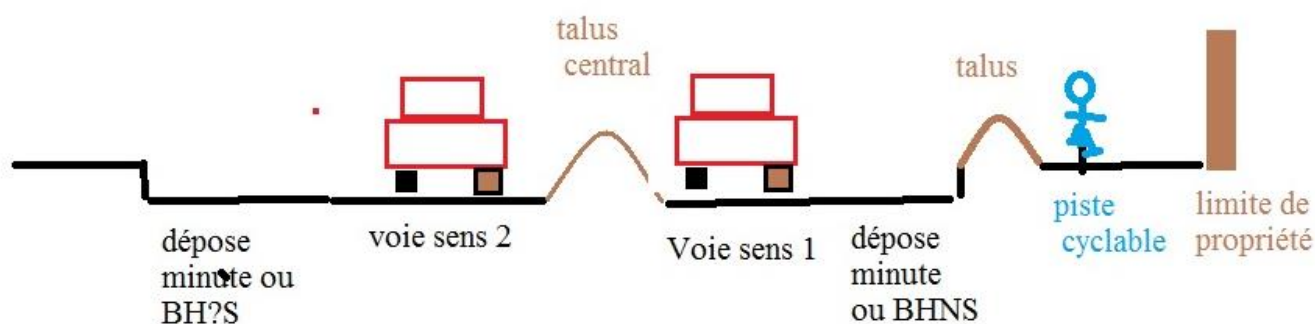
schéma de principe du profil de la RM5 tronçons central
